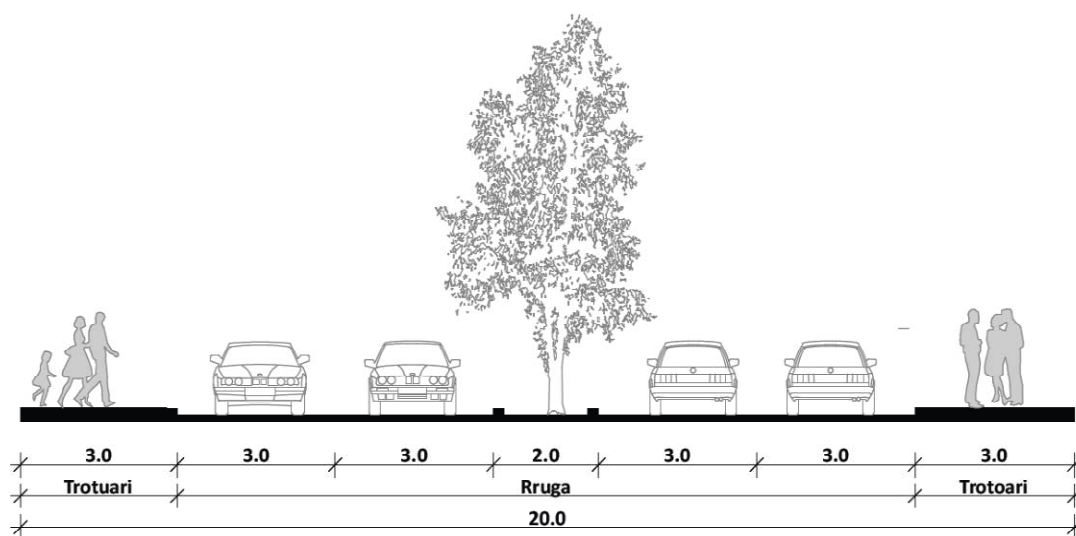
Prerja tërthore e rrugës Prizren-Gjakovë (R107)
